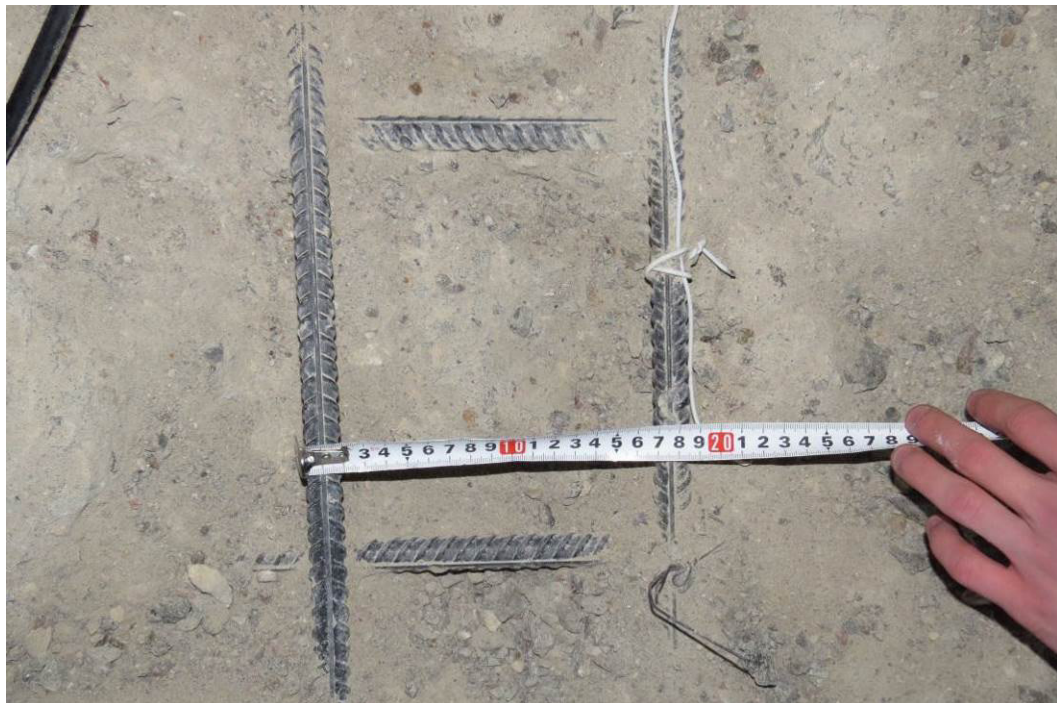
Замер шага продольных стержней вдоль цифровых осей верхней зоны армирования фундаментной плиты на участке вскрытия между осями 23-24, А-Б
